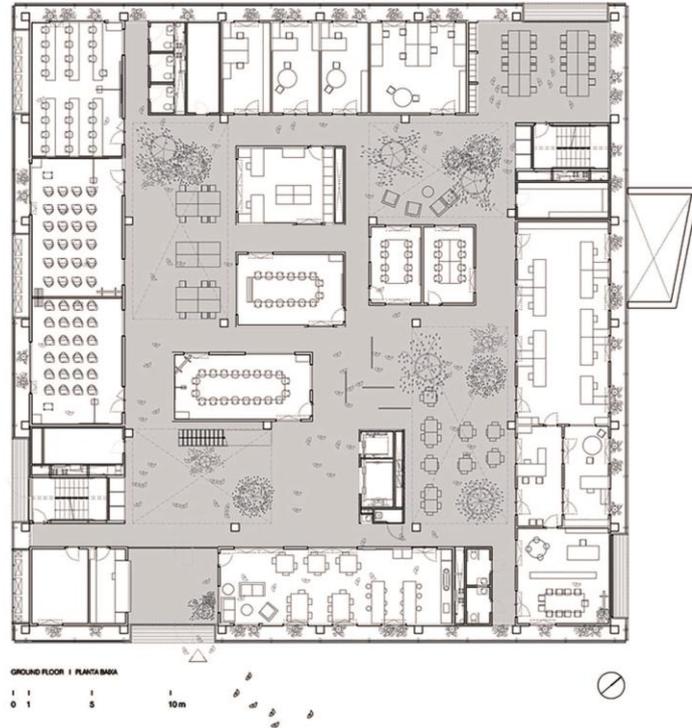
Planta baja del Centro de Investigación. Fuente: Archdaily, 2015. Elaboración: imagen de cortesía de DATAAE y H Arquitectes (2015). Archdaily.
